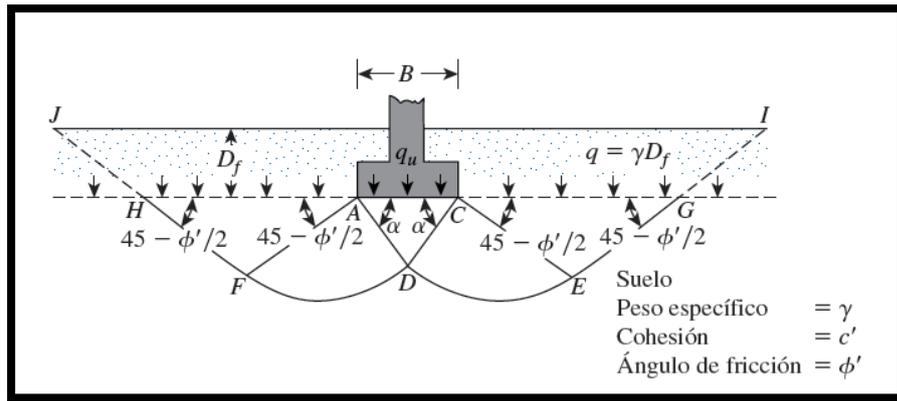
Falla por Capacidad de Carga en un Suelo Bajo una Cimentación Rígida continúa
